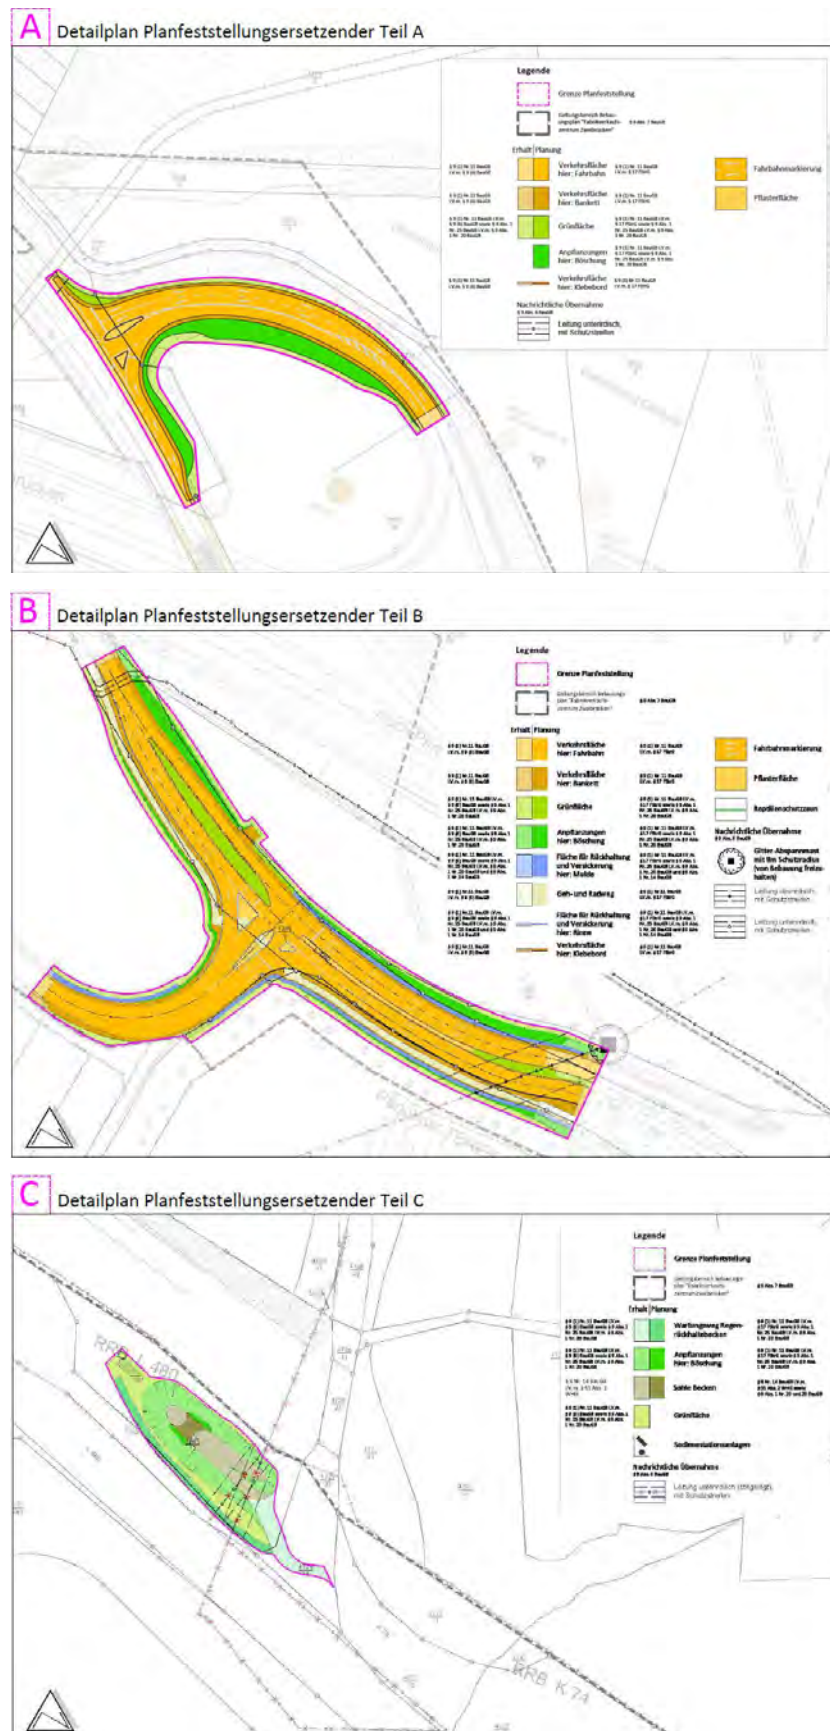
Bebauungsplan: Detailpläne Planfeststellungsersetzende Teile A-C
